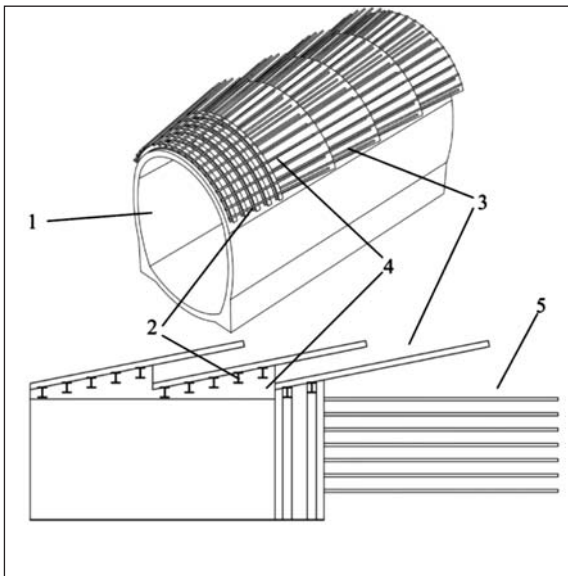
Конструкция передового крепления свода среднего станционного тоннеля: 1 – монолитная железобетонная обделка; 2 – стальные арки (стальные арки показаны только на одном участке, на остальных скрыты); 3 – трубы, заполненные бетоном; 4 – бетон низкого класса по прочности или набрызг-бетон; 5 – фиброгласовые анкера
